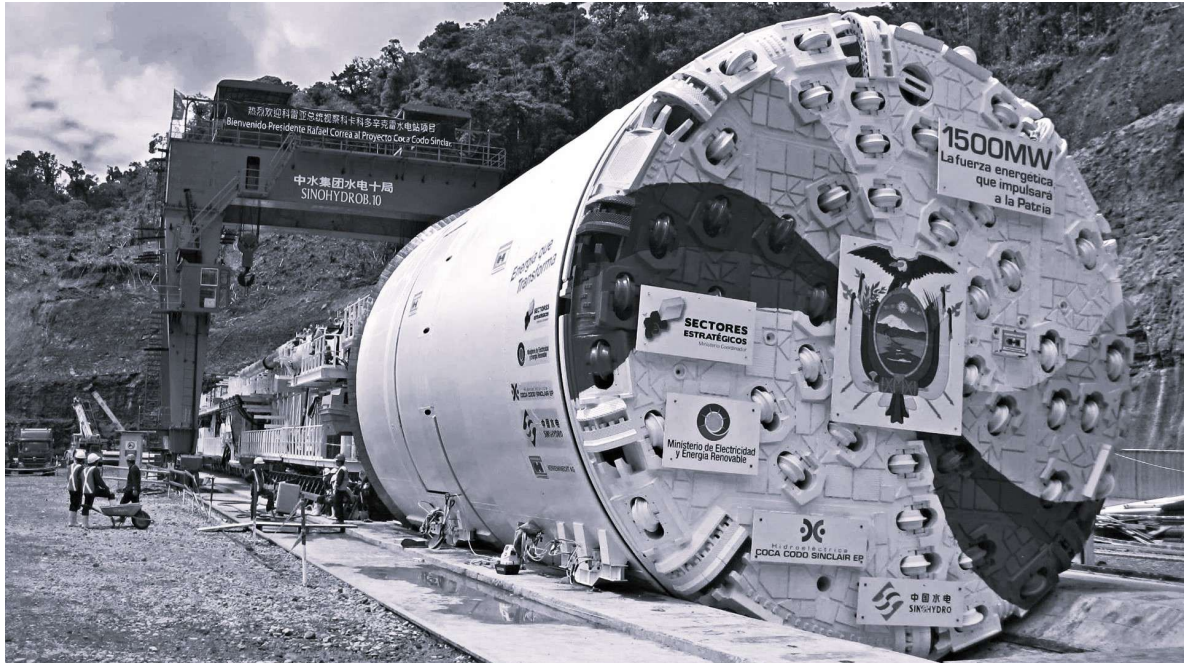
Tuneladora blindada ou com escudo (HERRENKNECHT TUNNELING SYSTEMS, 2015)
